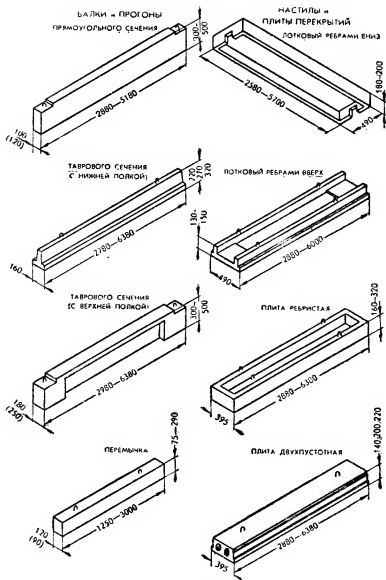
Балки, прогоны и настилы перекрытий, Перемычки.
